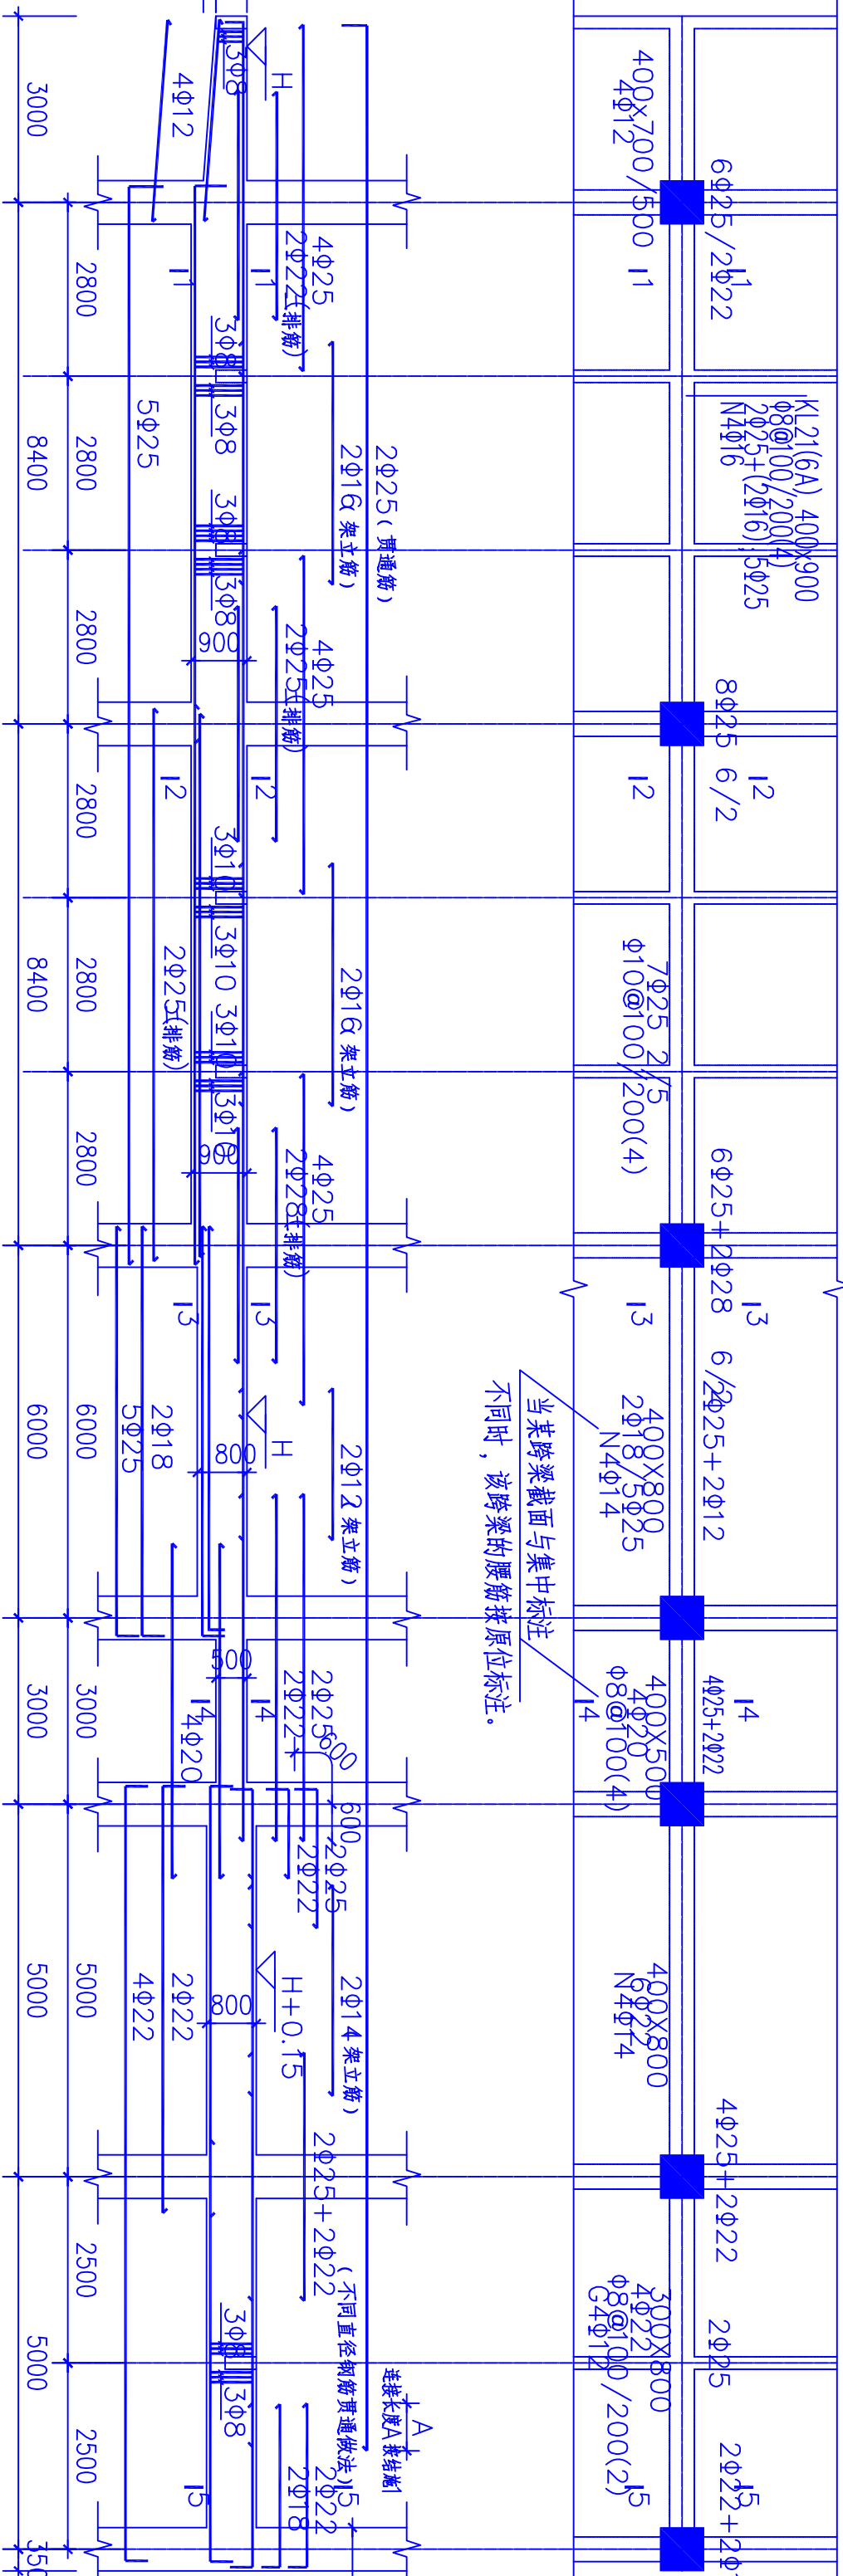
钢筋混凝土梁配筋平面表示法图例一 框架梁做法示例：KL21(6A)
